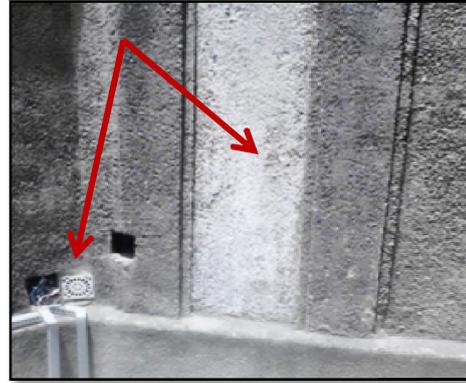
Detalhe da seção pintada de branco e da fiação exposta na fachada sudoeste.
